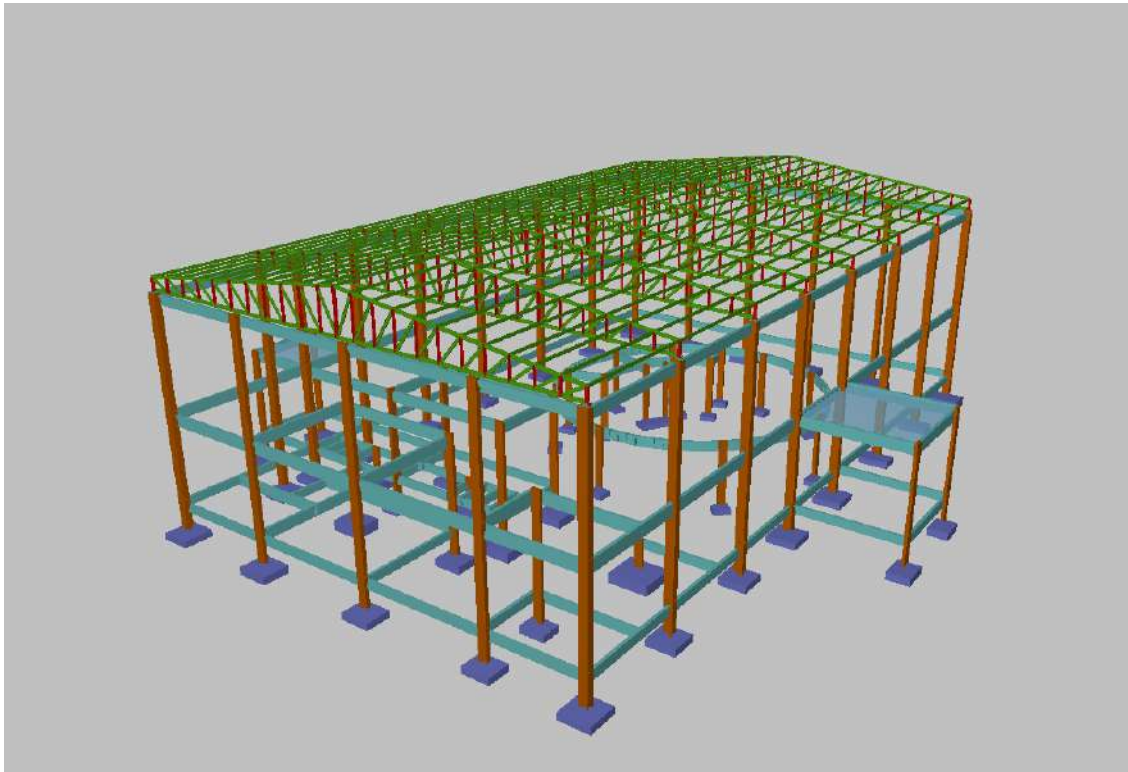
Modelado de Unión entre Estructura Metálica y Estructura de Hormigón Armado.
